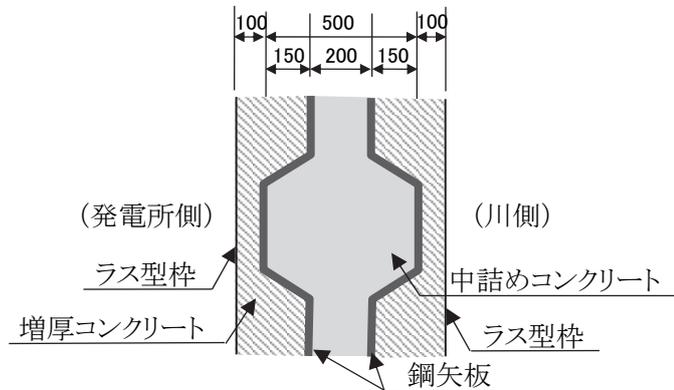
閉塞方法イメージ断面図 (水平断面)
